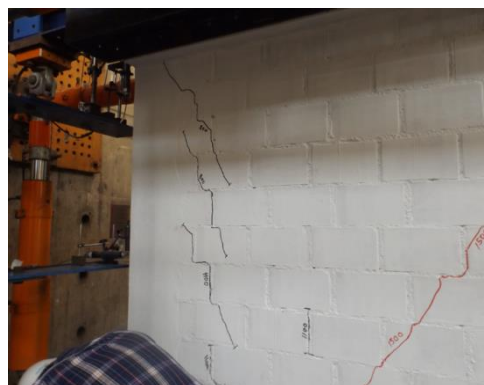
Formación de más grieta diagonales cercanas a las columnas para la distorsión 1/800.
